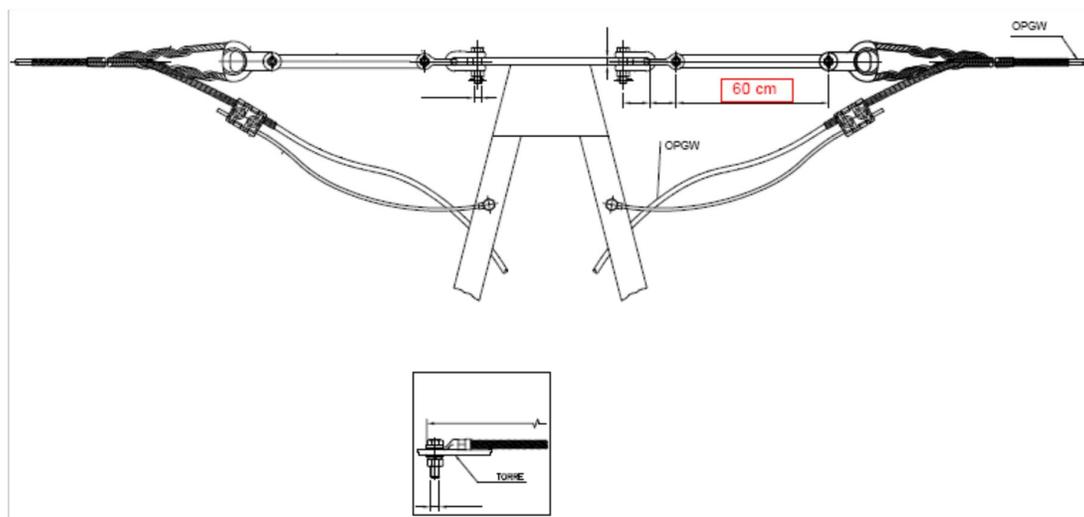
Referencia de conjunto de amarre bajante de OPGW para ser instalado en los 2 extremos de la torre
